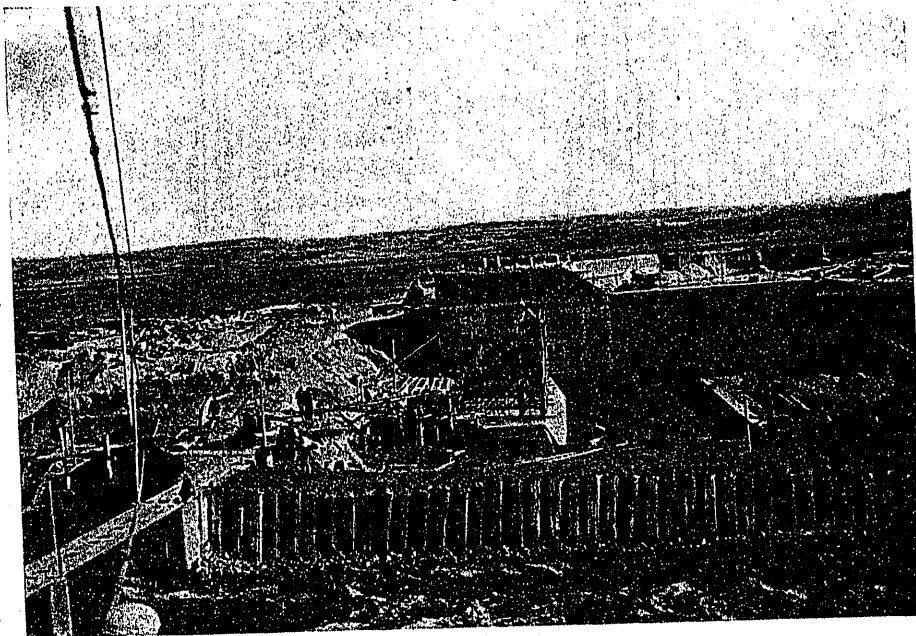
La presa en construcción, con las armaduras de varios contrafuertes colocadas.
